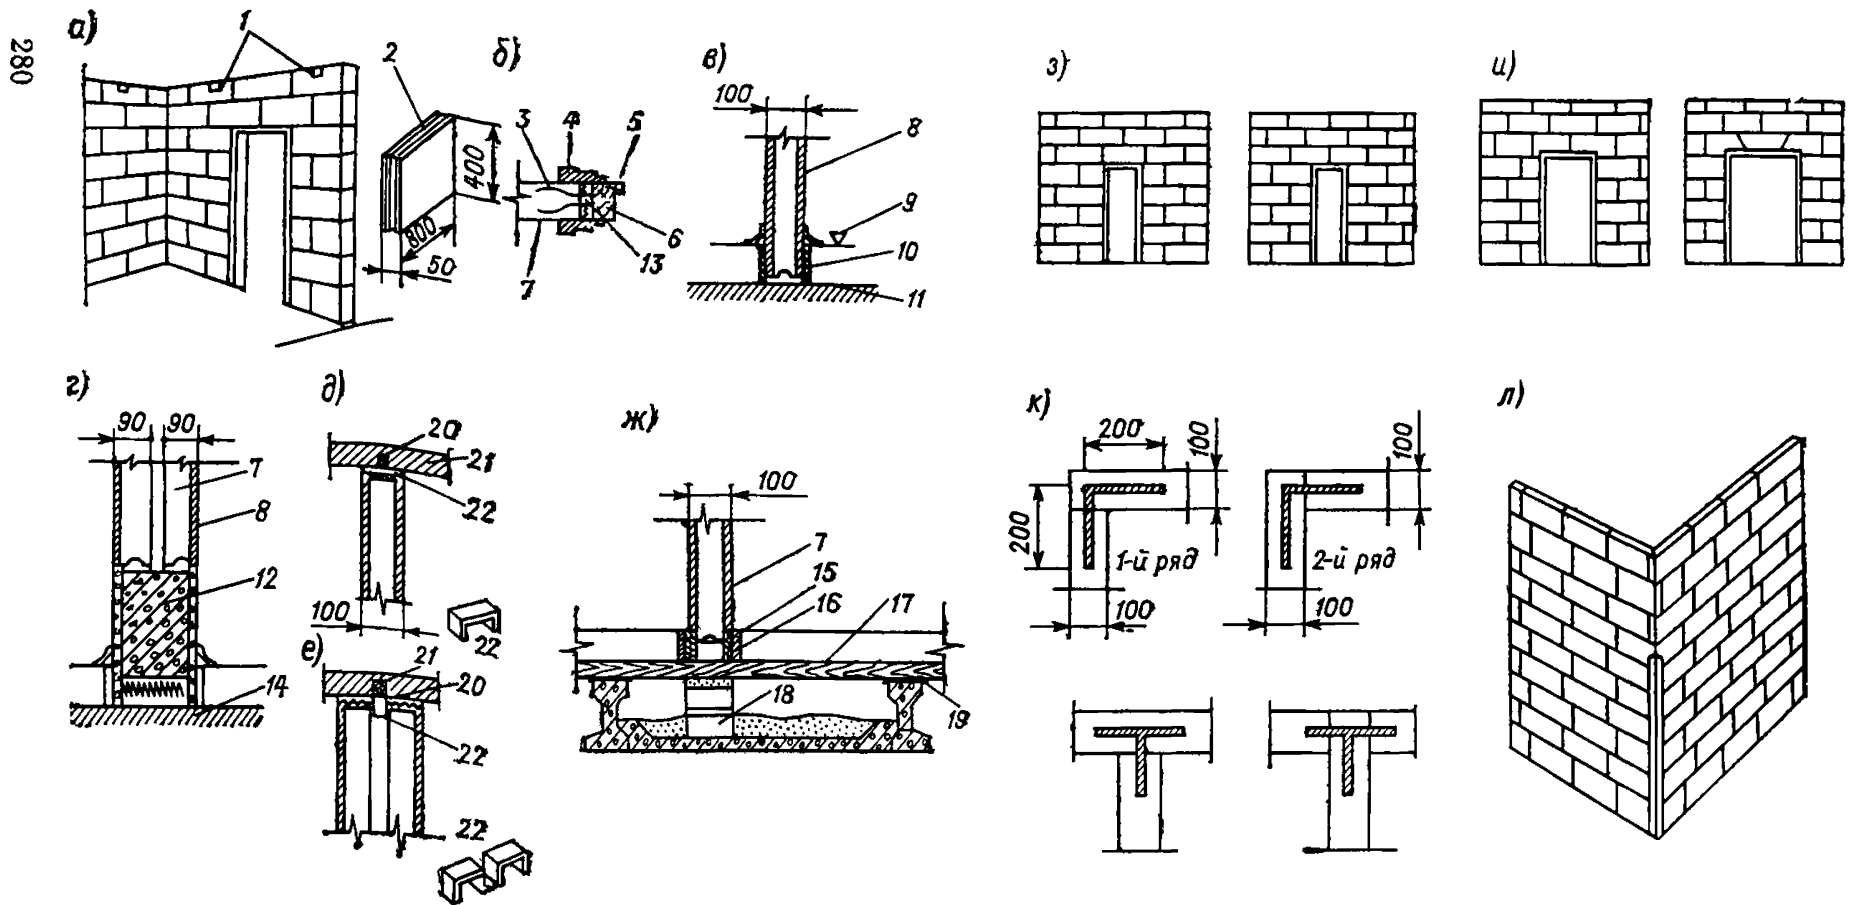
Общий вид перегородок из мелкоформатных гипсовых, гипсошлаковых и шлакобетонных плит
